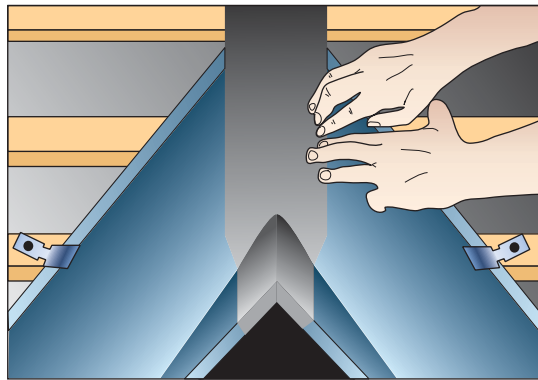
Подготовка ендовы длиной равной скату крыши под укладку черепицы
